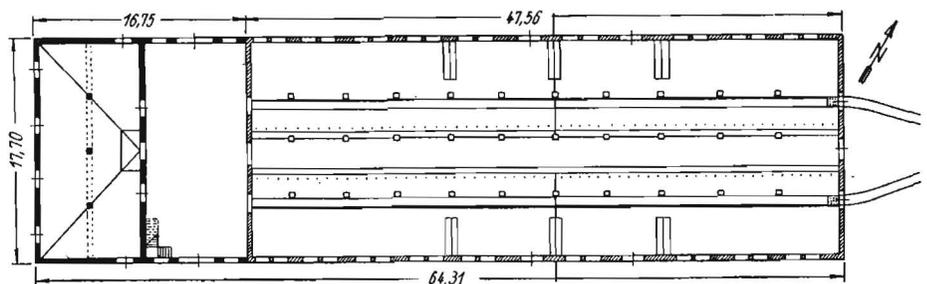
Grundriß des Laufstalles mit Futtertenne und Rübenlager. Rechts zusammengeführt die Schleppschaufelbahnen
